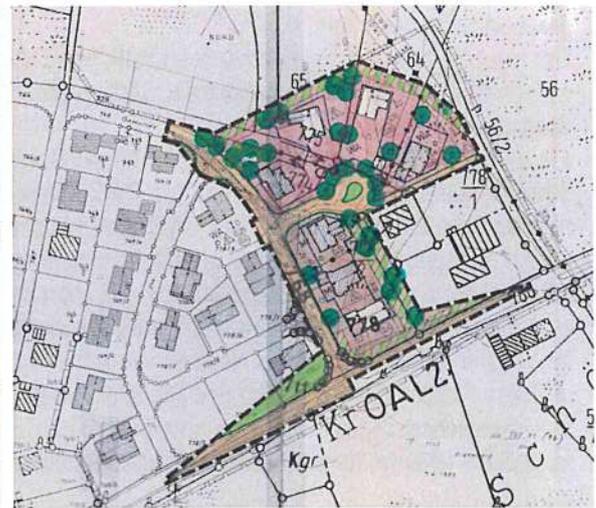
Bebauungsplan Nr. 2 „Pröbsten - Ost“
